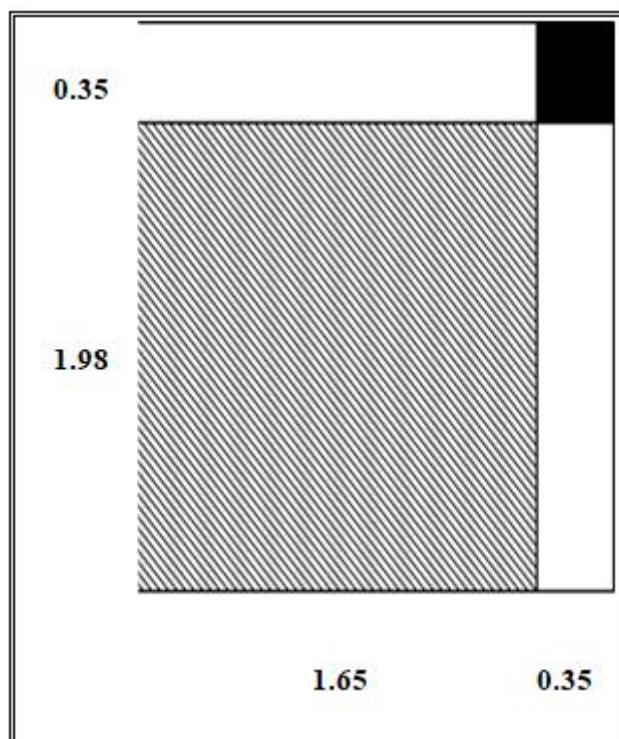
Croquis d'un poteau d'angle (A-7)
